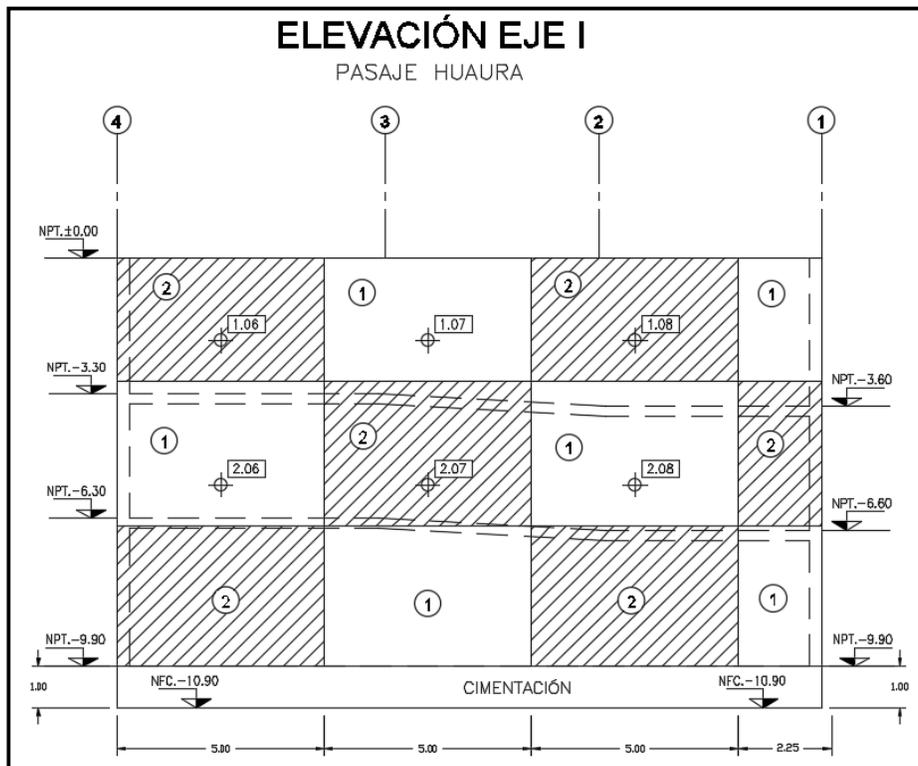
Elevación típica de muro anclado obra 2 – Edificio Crossland.
